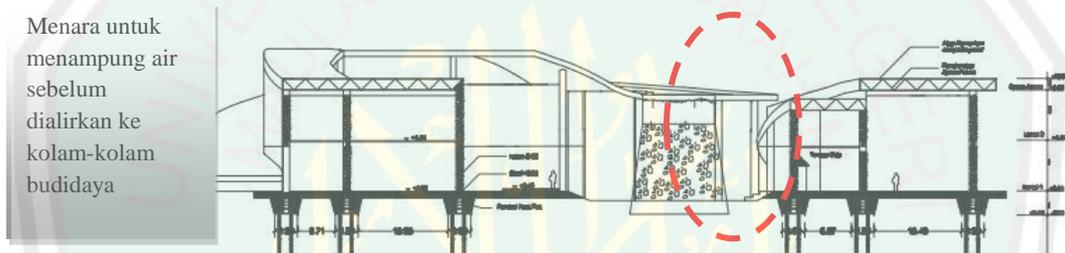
Denah Bangunan Pusat Budidaya ikan Hias
